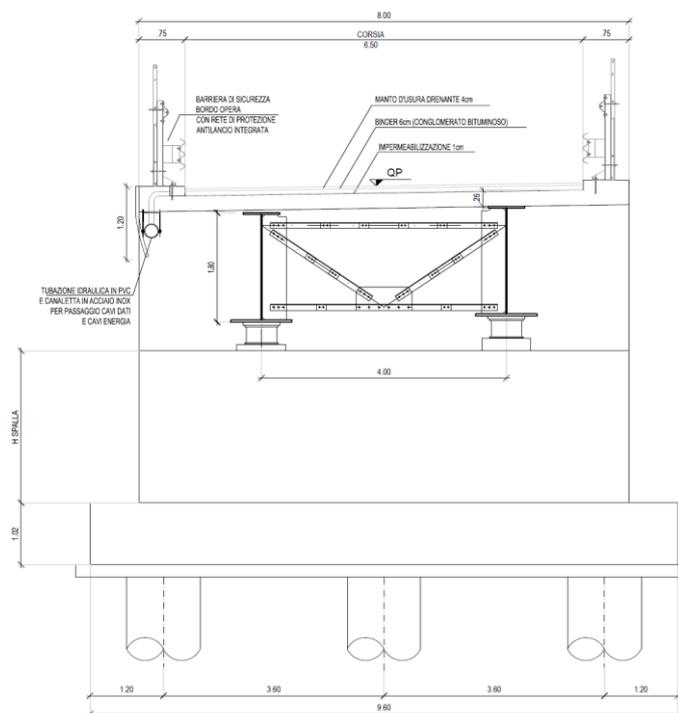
Sezione trasversale impalcati viabilità secondaria
